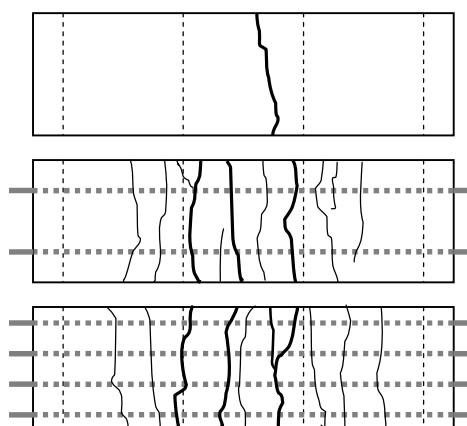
ひび割れ図 (No.1: 鋼繊維なし)
